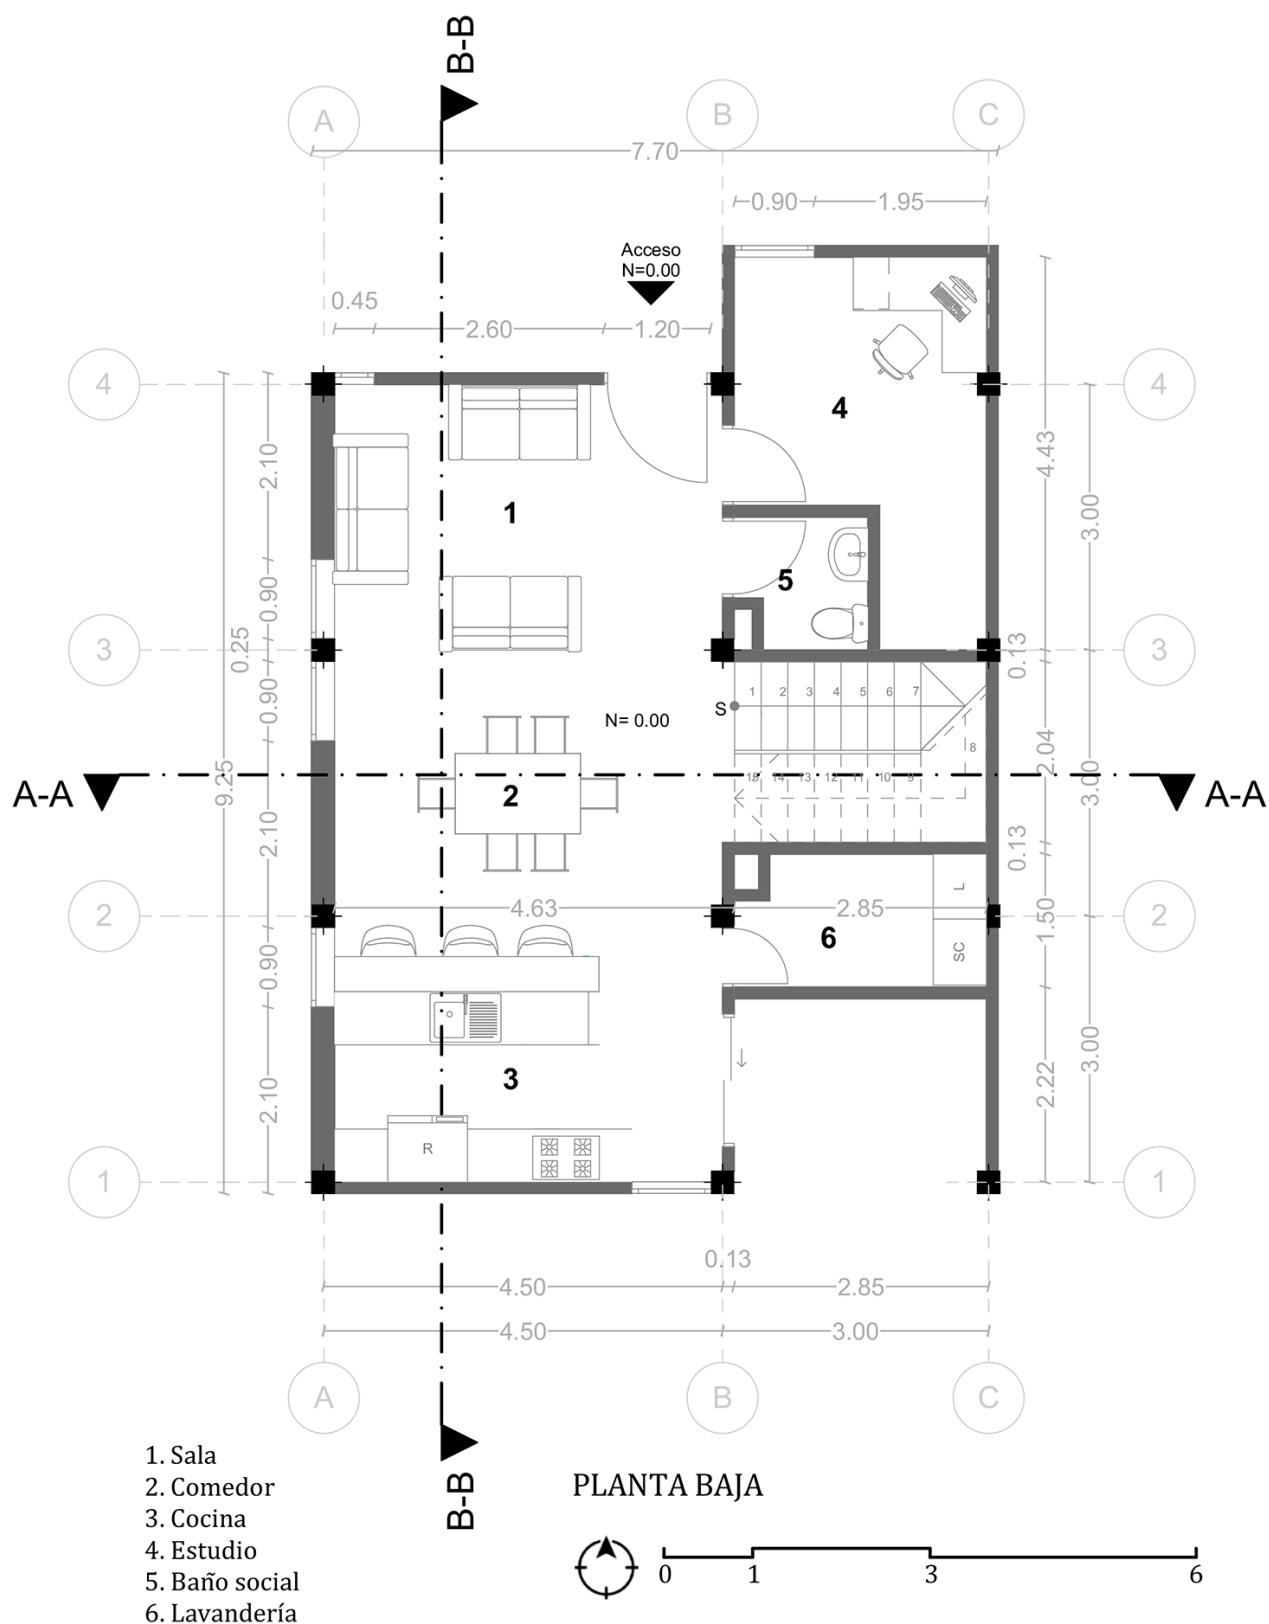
Planta baja de propuesta. Escala gráfica.
